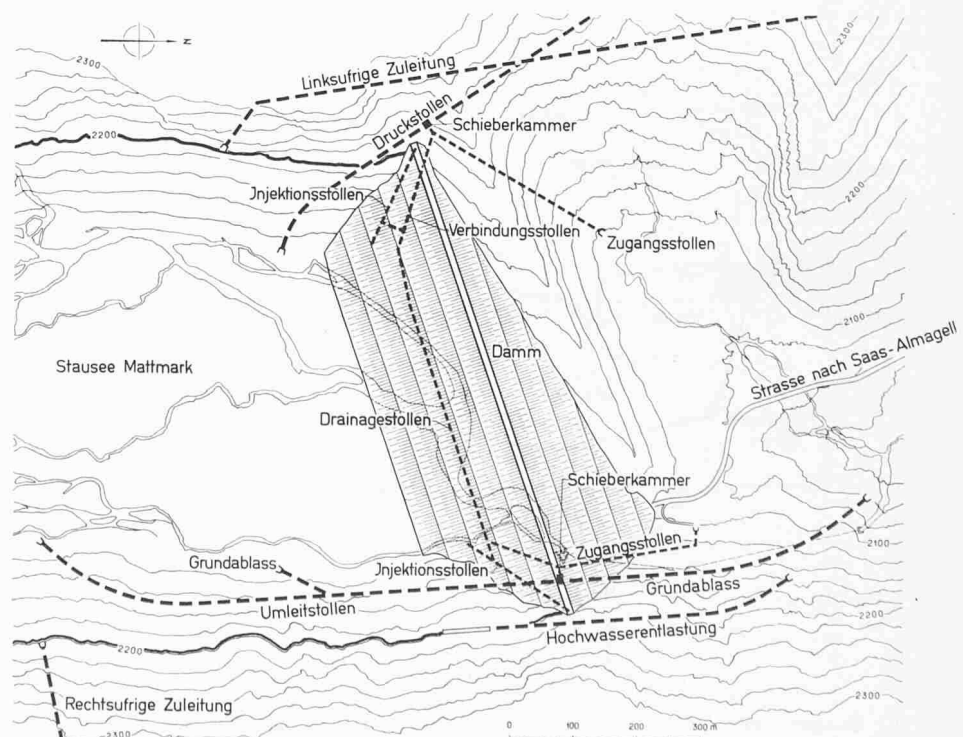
Staudamm Mattmark, Lageplan 1:12 000
